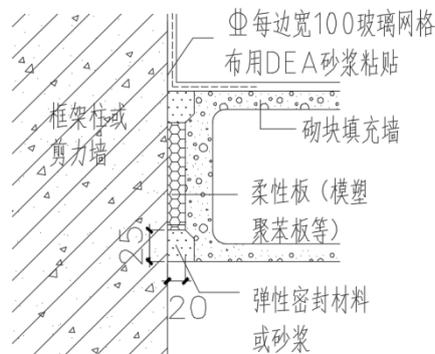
轻集料连锁免抹灰砌块内外填充墙与钢筋混凝土主体结构连接示意一
